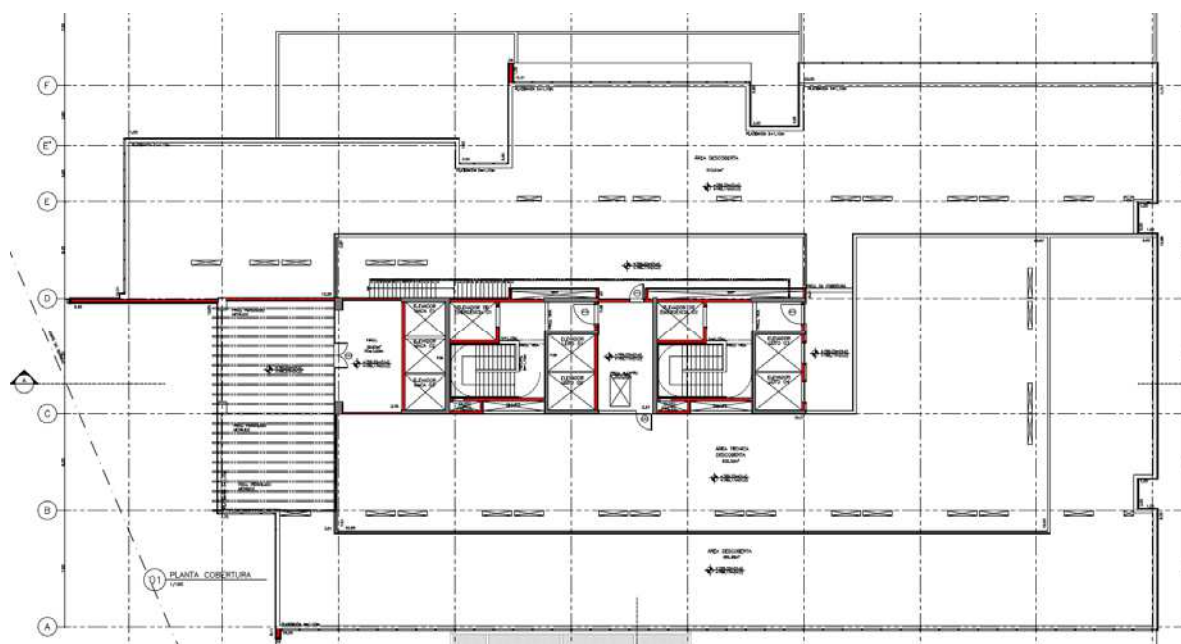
Planta da cobertura. Área técnica descoberta e caixas d'água e barriletes.
